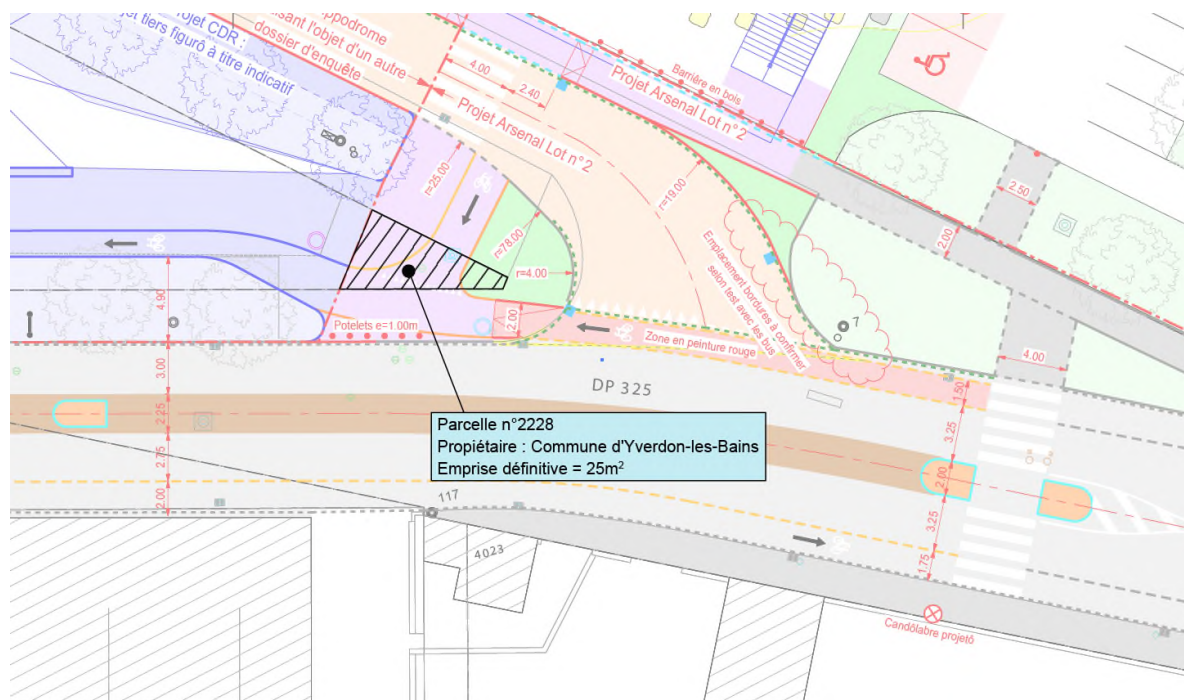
Plan d'emprise sur la parcelle communale n° 2228
